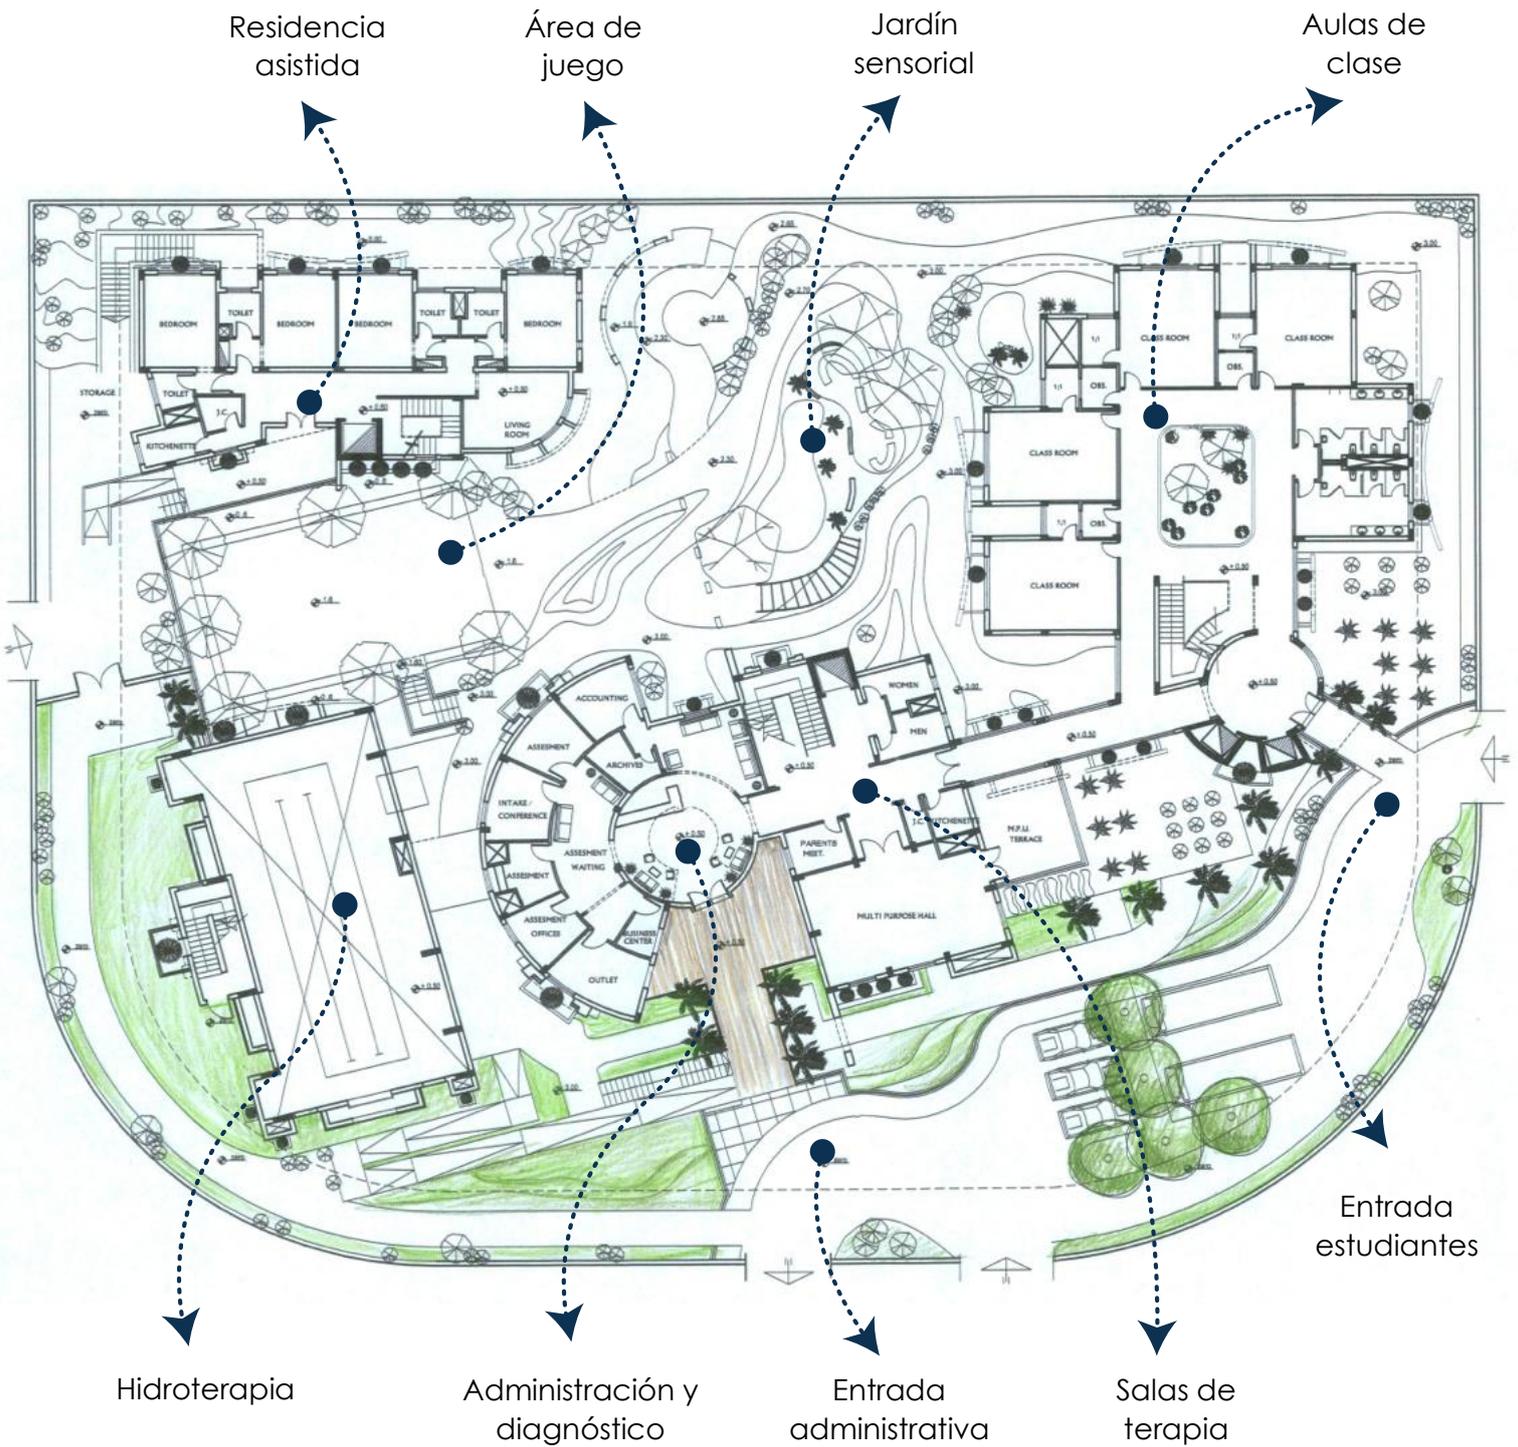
Planta arquitectónica - Advance Centre for special needs
